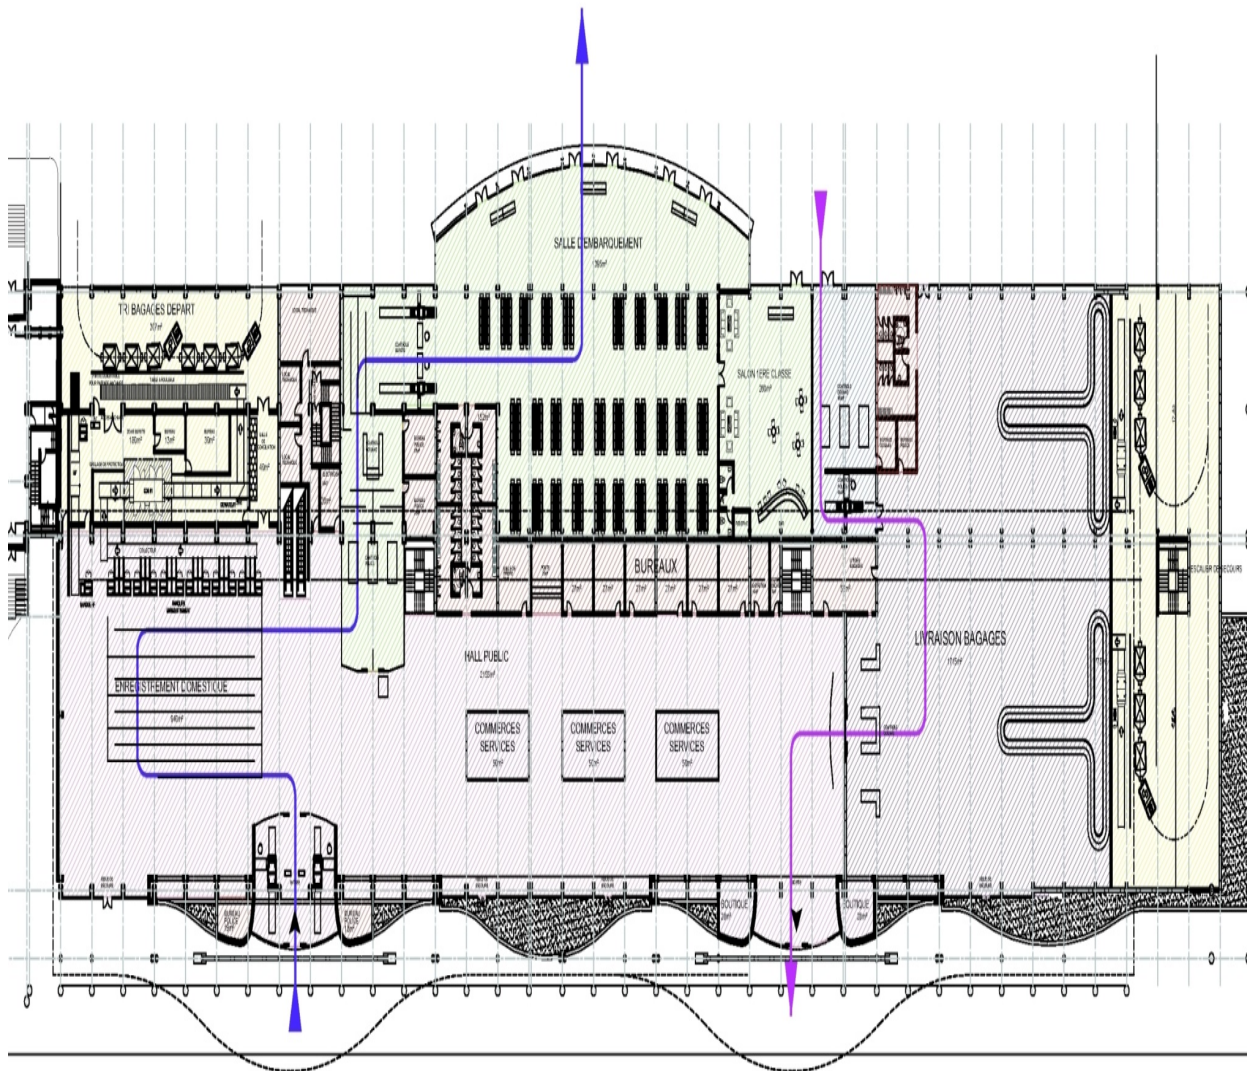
Cheminement passagers -Plan du 1er étage
